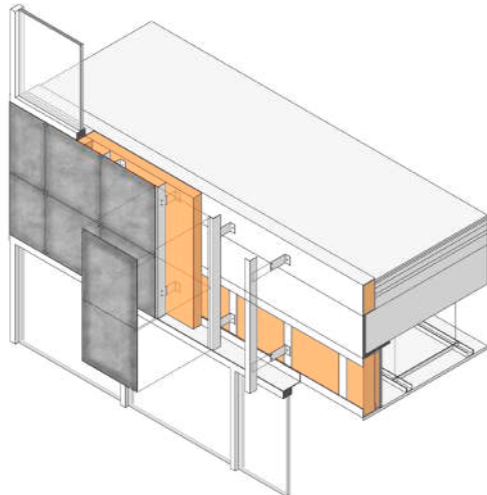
Axonometría detalle fachada Fuente: elaboración propia
